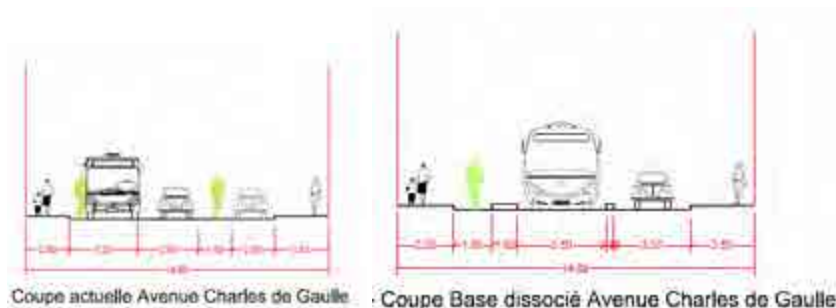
Exemple du profil proposé Avenue Charles de Gaulle
